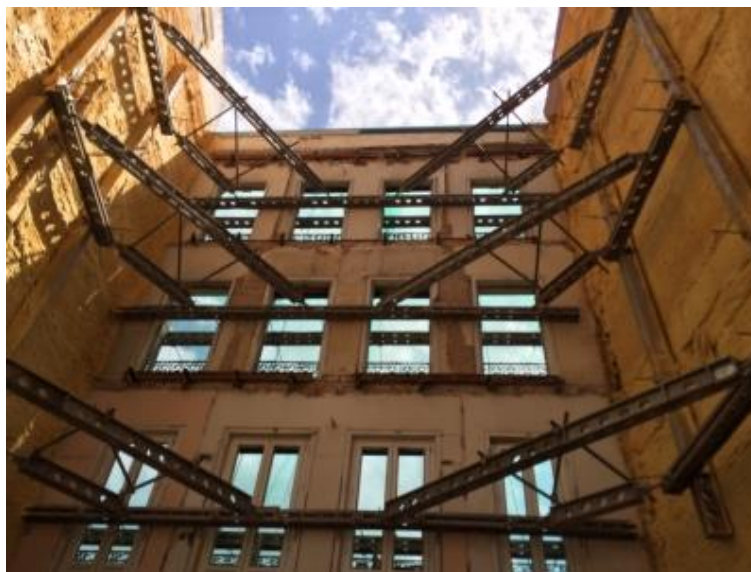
Arriostramiento interior de fachada. Fuente: Cylex.
